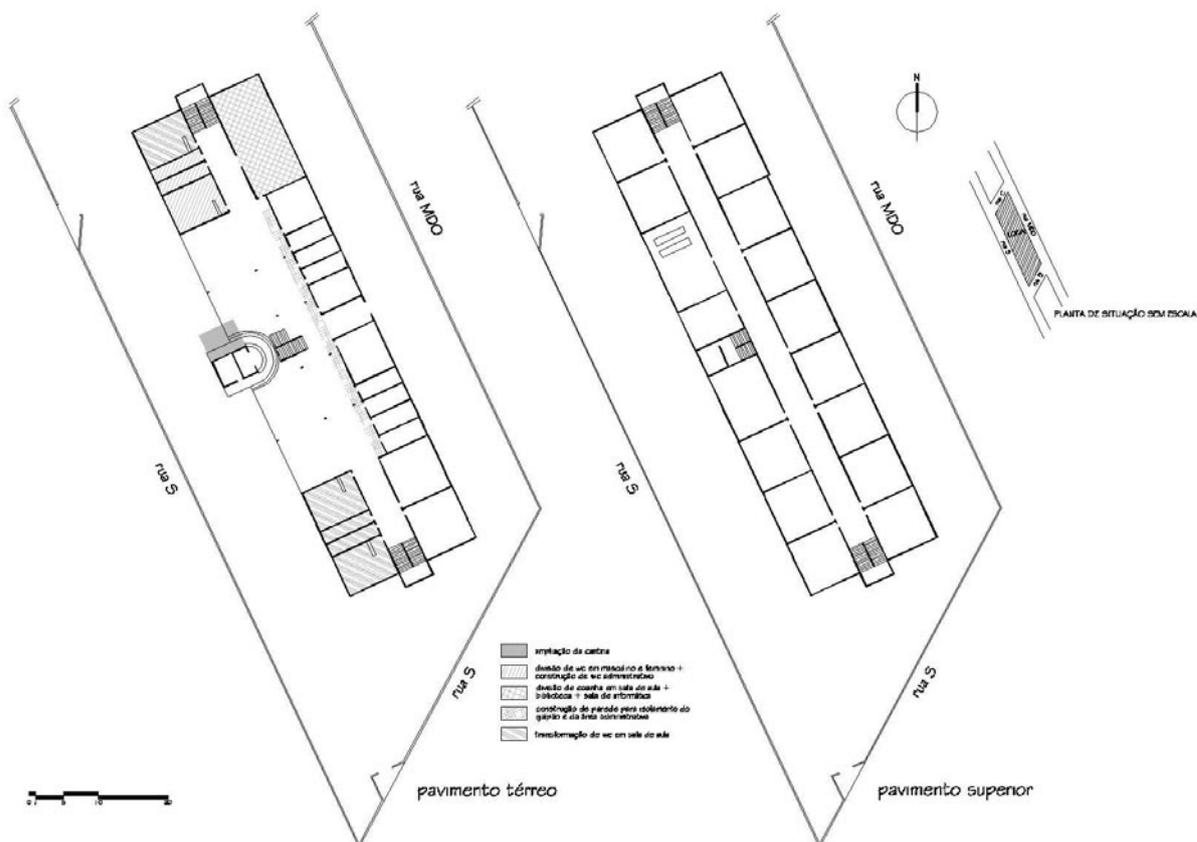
CROQUIS DE ADEQUAÇÃO DO PRÉDIO DA ESCOLA C EM RELAÇÃO À SUA PLANTA ORIGINAL (atualizado em Maio de 2004)
